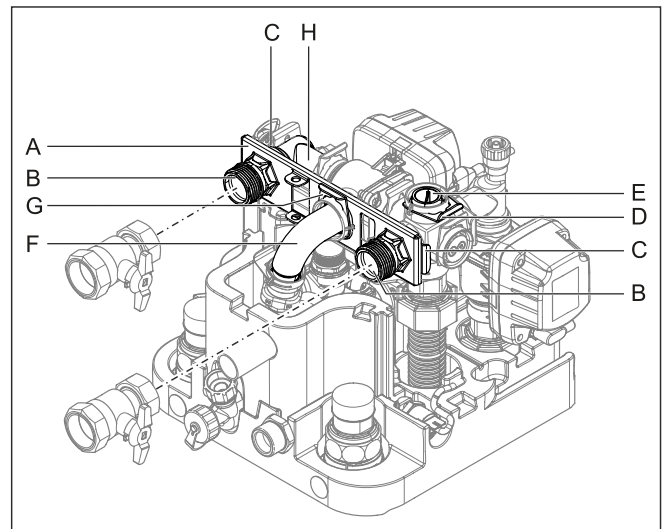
Ligações da alimentação e do retorno do aquecimento orientadas para trás
